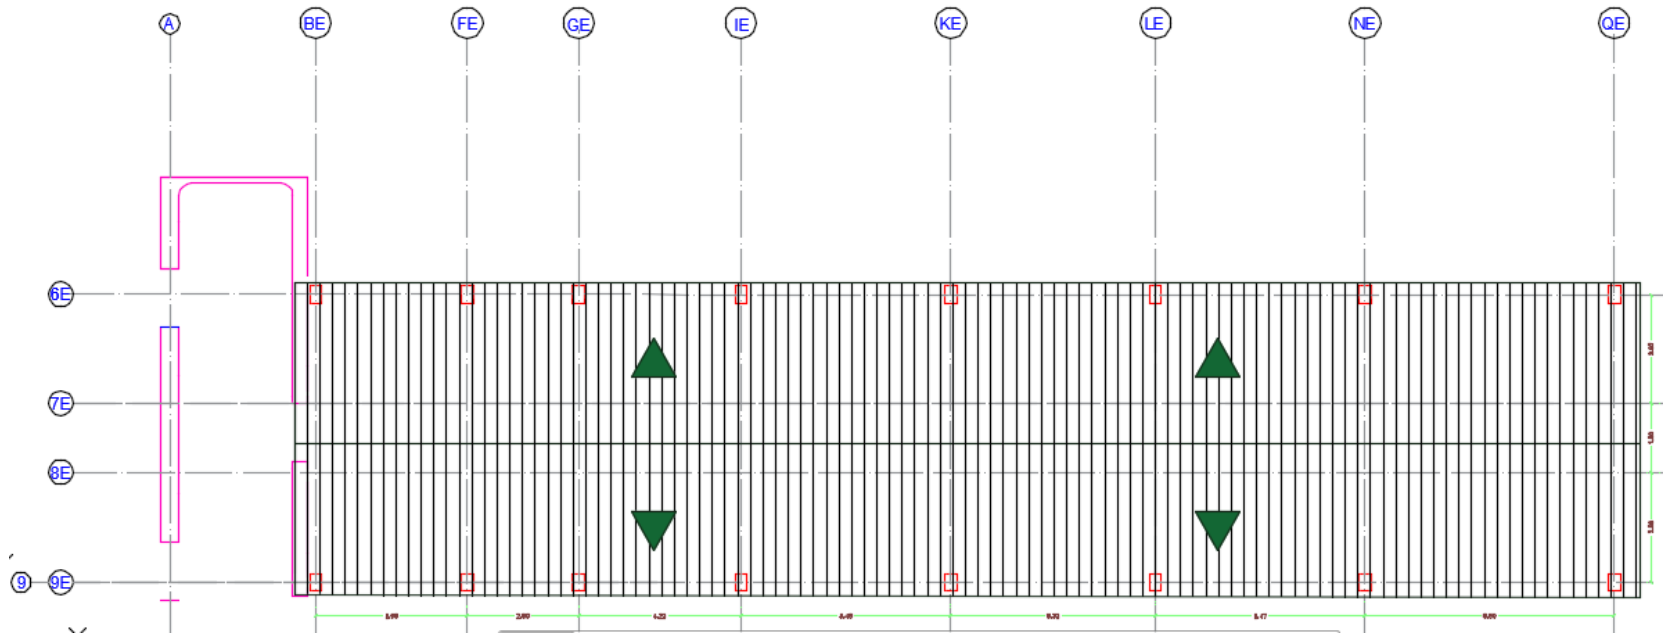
Propuesta de cubierta a dos aguas para la zona B. Fuente: Autor.
